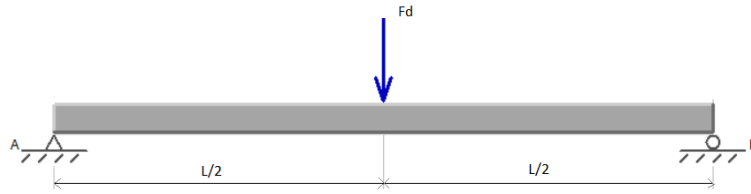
Viga simplesmente apoiada com carga a meio vão.
